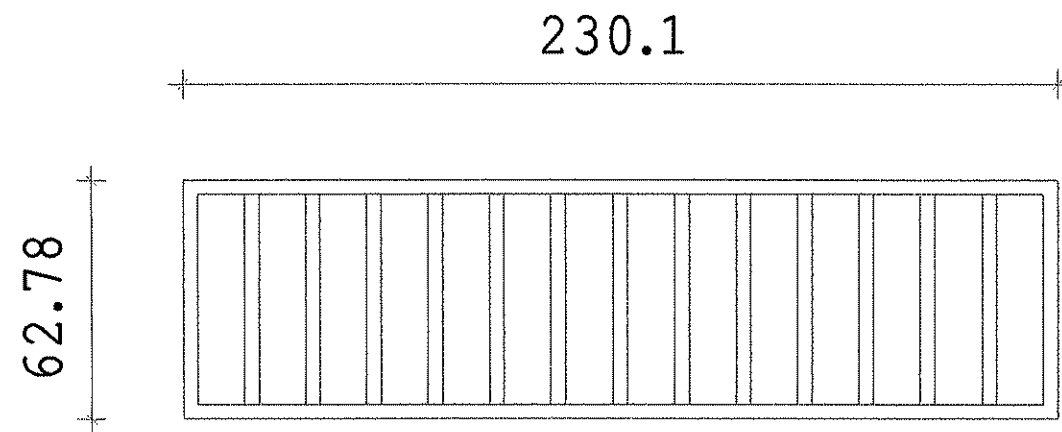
DETAIL DES MENUISERIES ech : 1/20e et 1/25e
